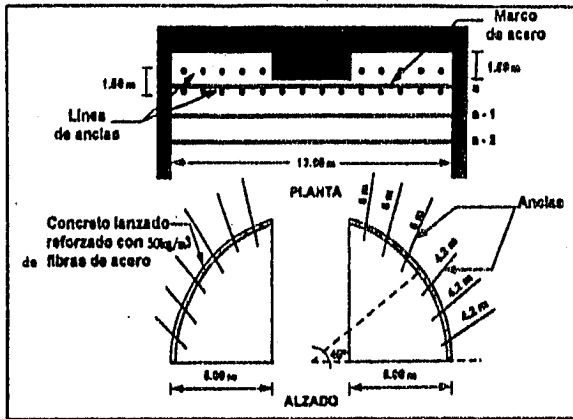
Anclaje de los laterales utilizando elementos de 6 m arriba de la inclinación de 45° y de 4.20 m abajo.
